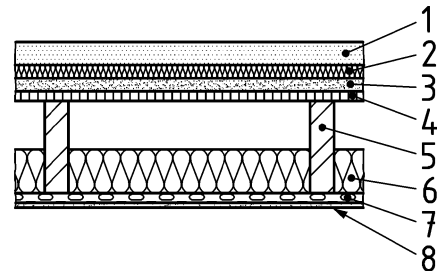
Deckenkonstruktion der Wohnungstrenndecke
